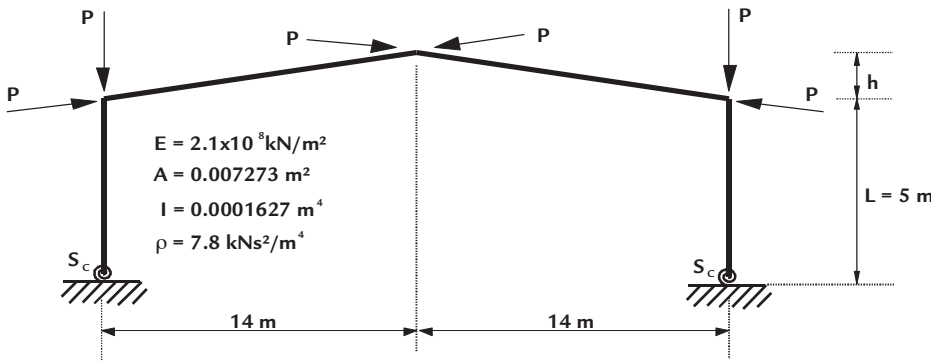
Pórtico do tipo galpão: geometria e carregamento.
